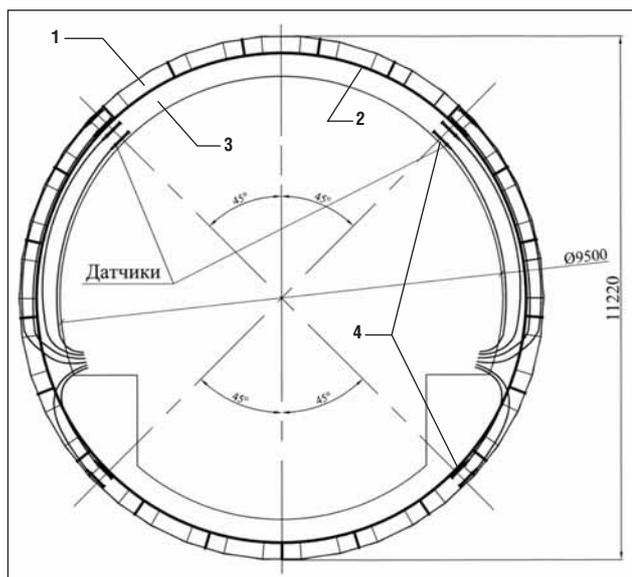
Конструкция крепи и обделки: 1 – крепь из стальных двутавровых арок и бетона в межарочном пространстве, 2 – гидроизоляция, 3 – монолитная железобетонная обделка, 4 – датчики
